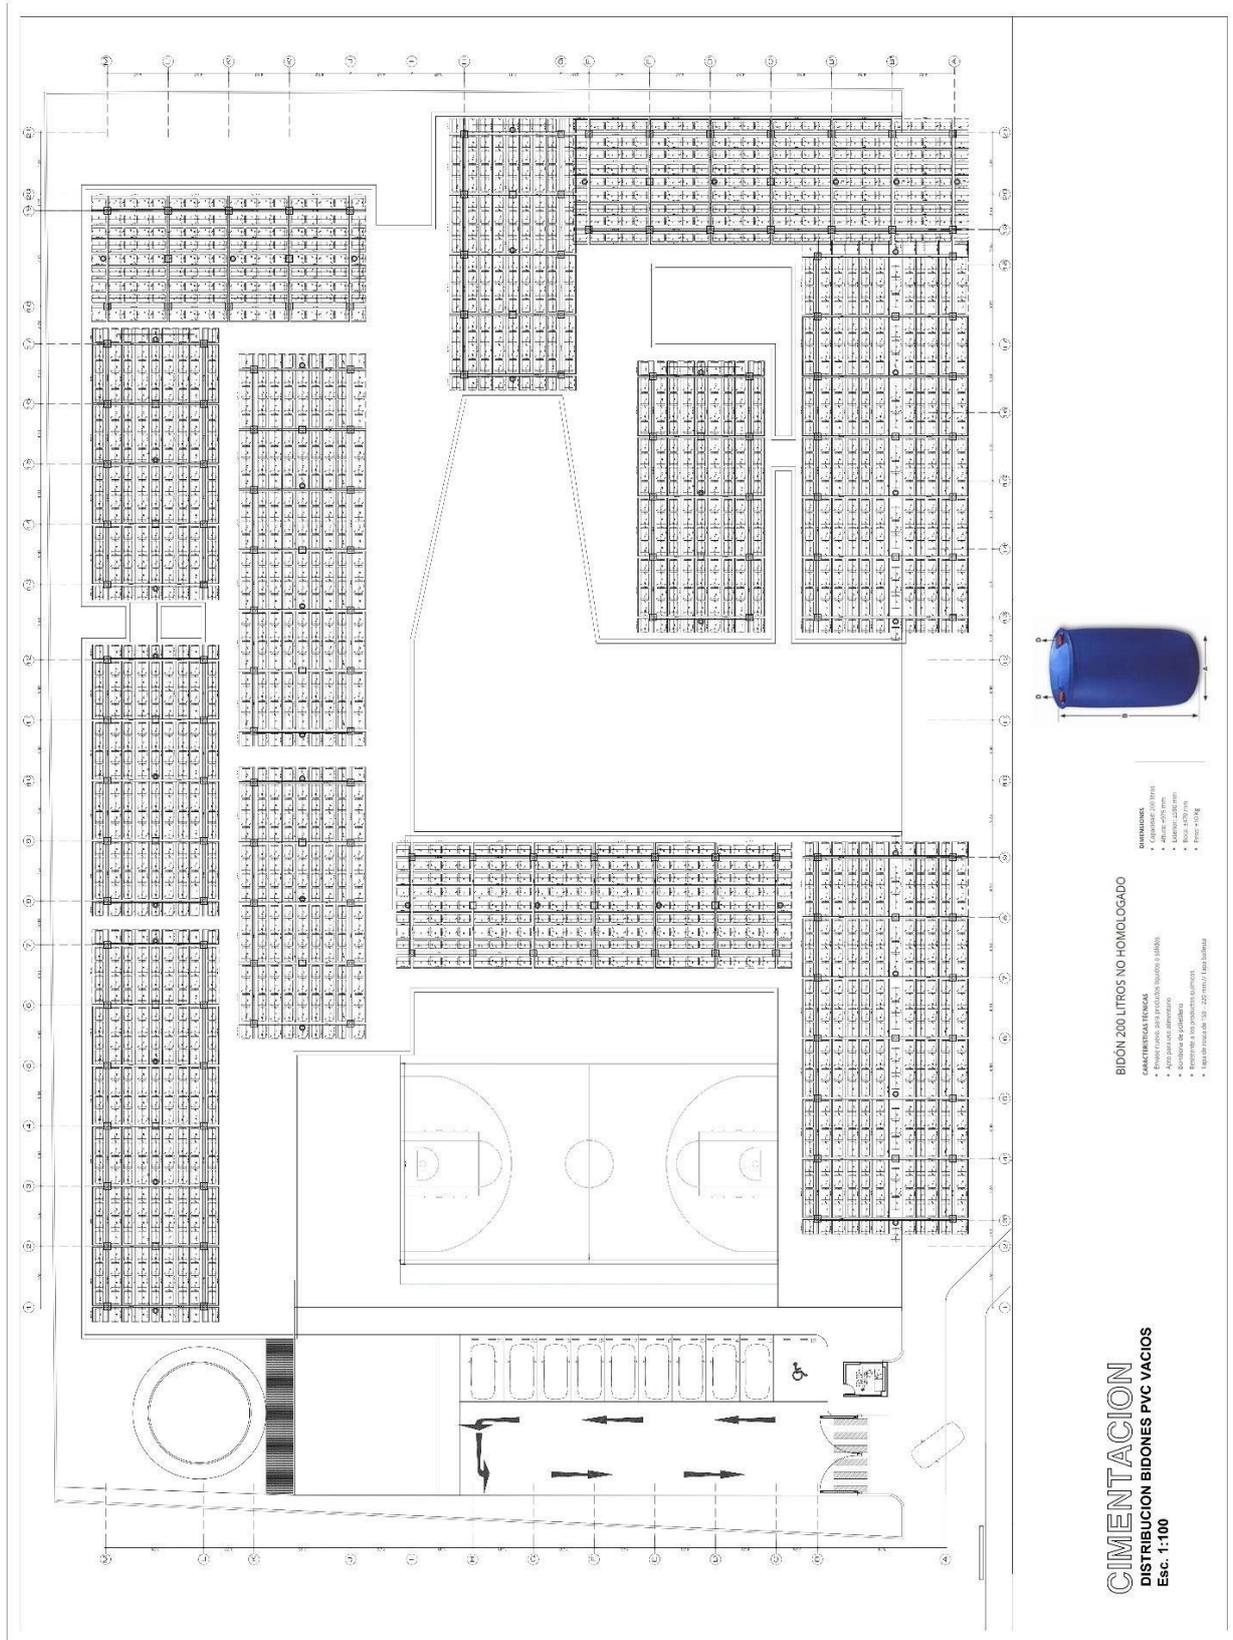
Planos de Cimentación: Entablado de pisos y columnas
